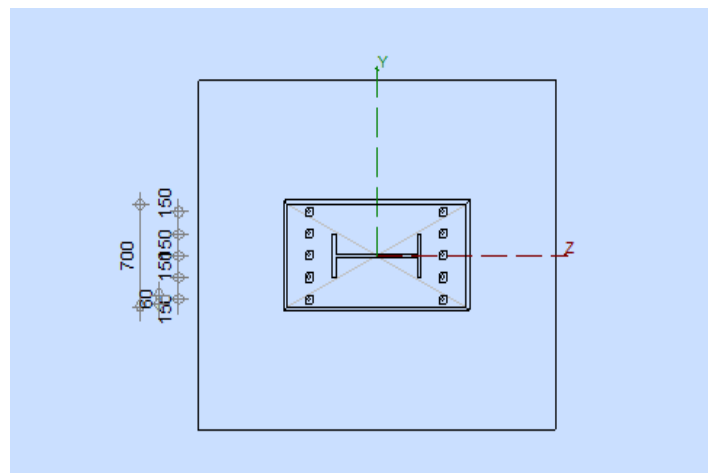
Disposition d'assemblage de pieds de poteau .
